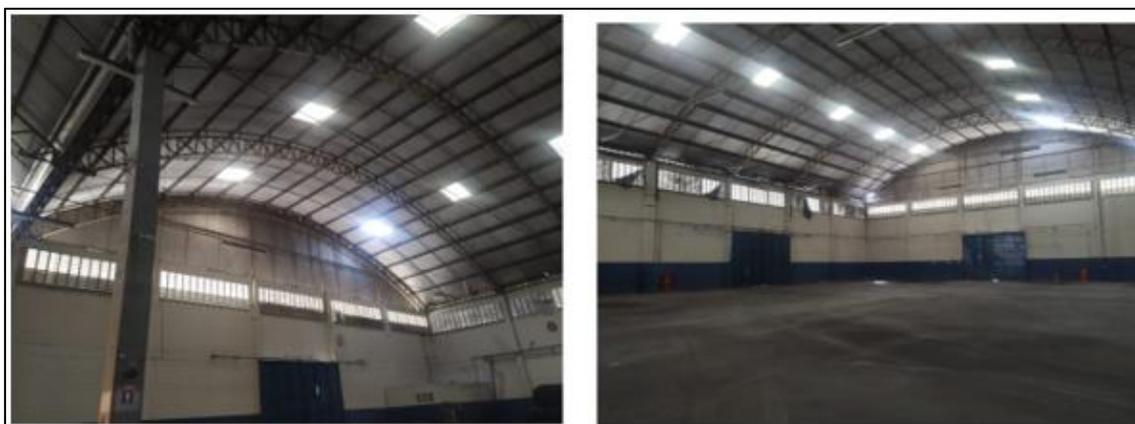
Estruturas de concreto, cobertura, telhas de fibrocimento e praça.
